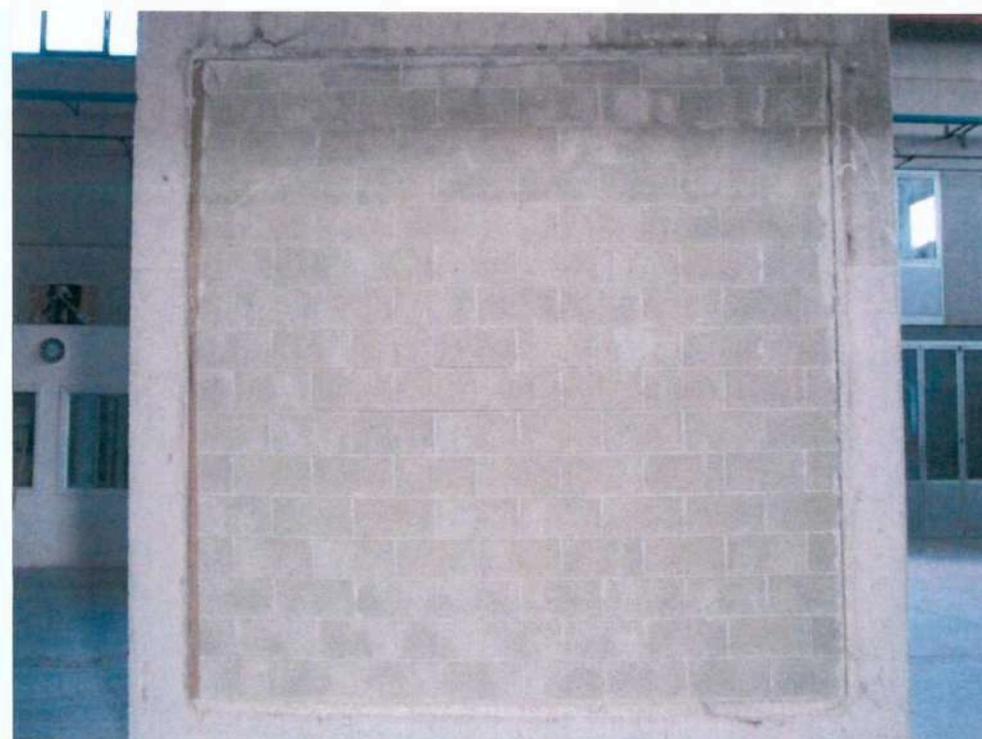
Estratto da rapporto di prova I.G. nr°333959/3794FR parete in blocchi in calcestruzzo normale sp. 12 cm protetta con MULTIPOR 045 dal lato opposto al fuoco.
